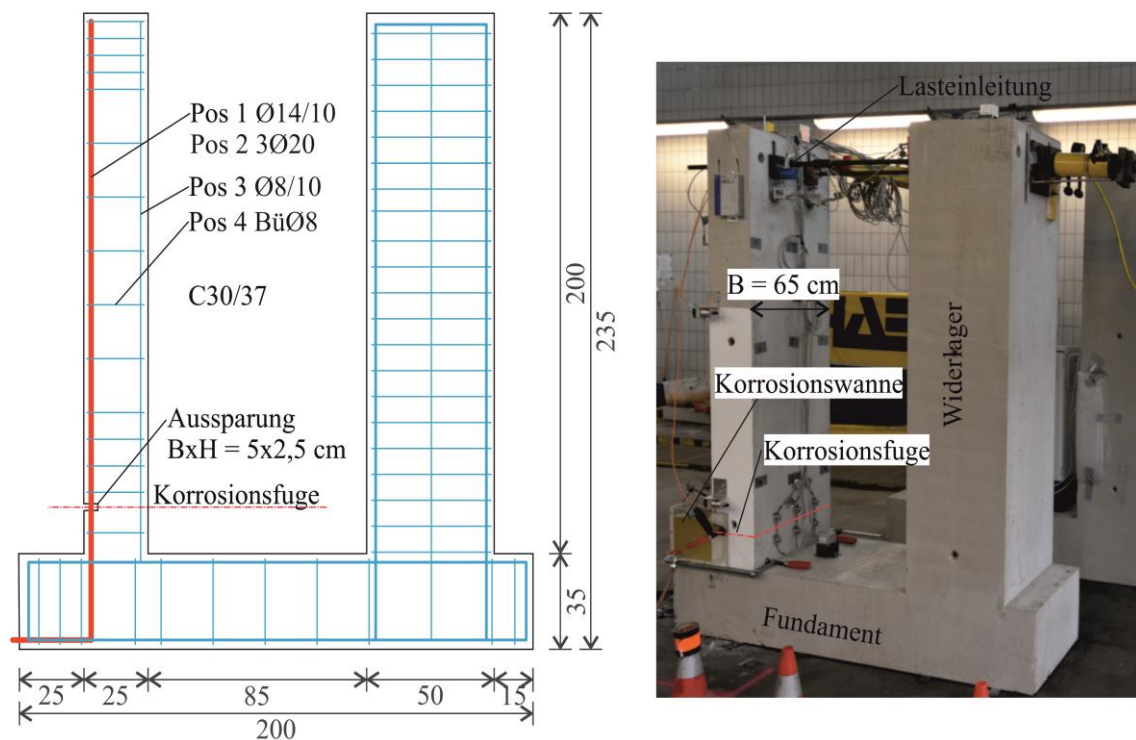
Darstellung des Versuchsstandes SIBS\_V2; Links: Bewehrungsskizze; Rechts: Versuchsaufbau
